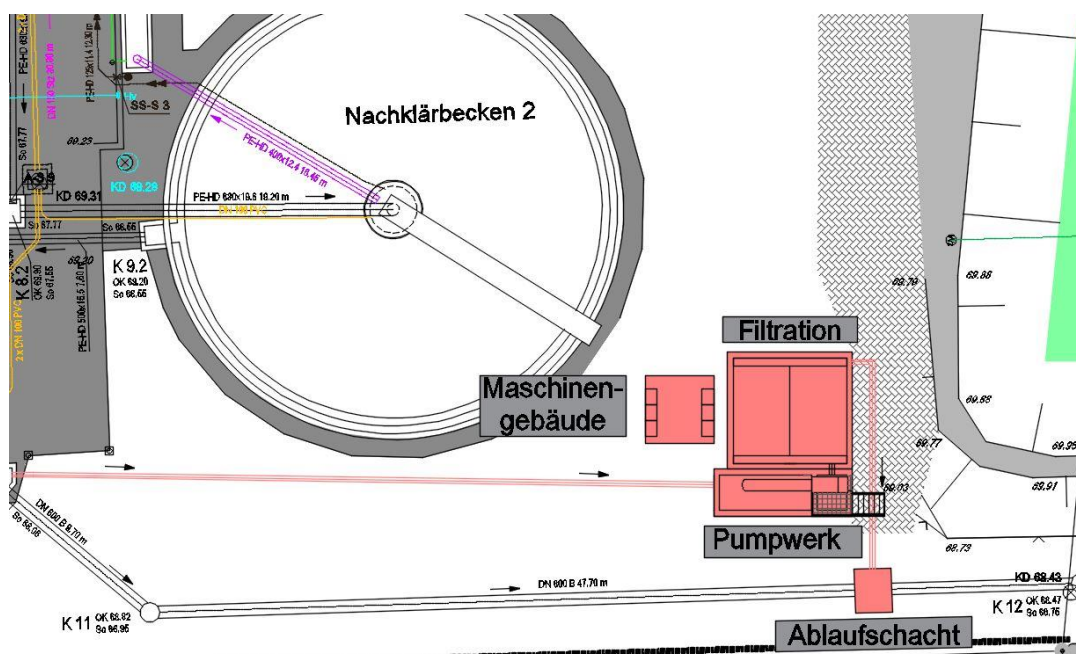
Anordnung der erforderlichen Bauteile für Variante 1b im Lageplan
